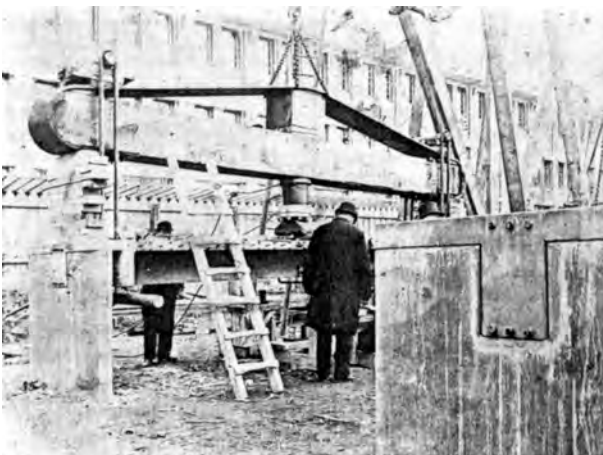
Experimentos de Hennebique em viga de concreto armado em Bon Marché. [RASSEGNA n°49]:25a
